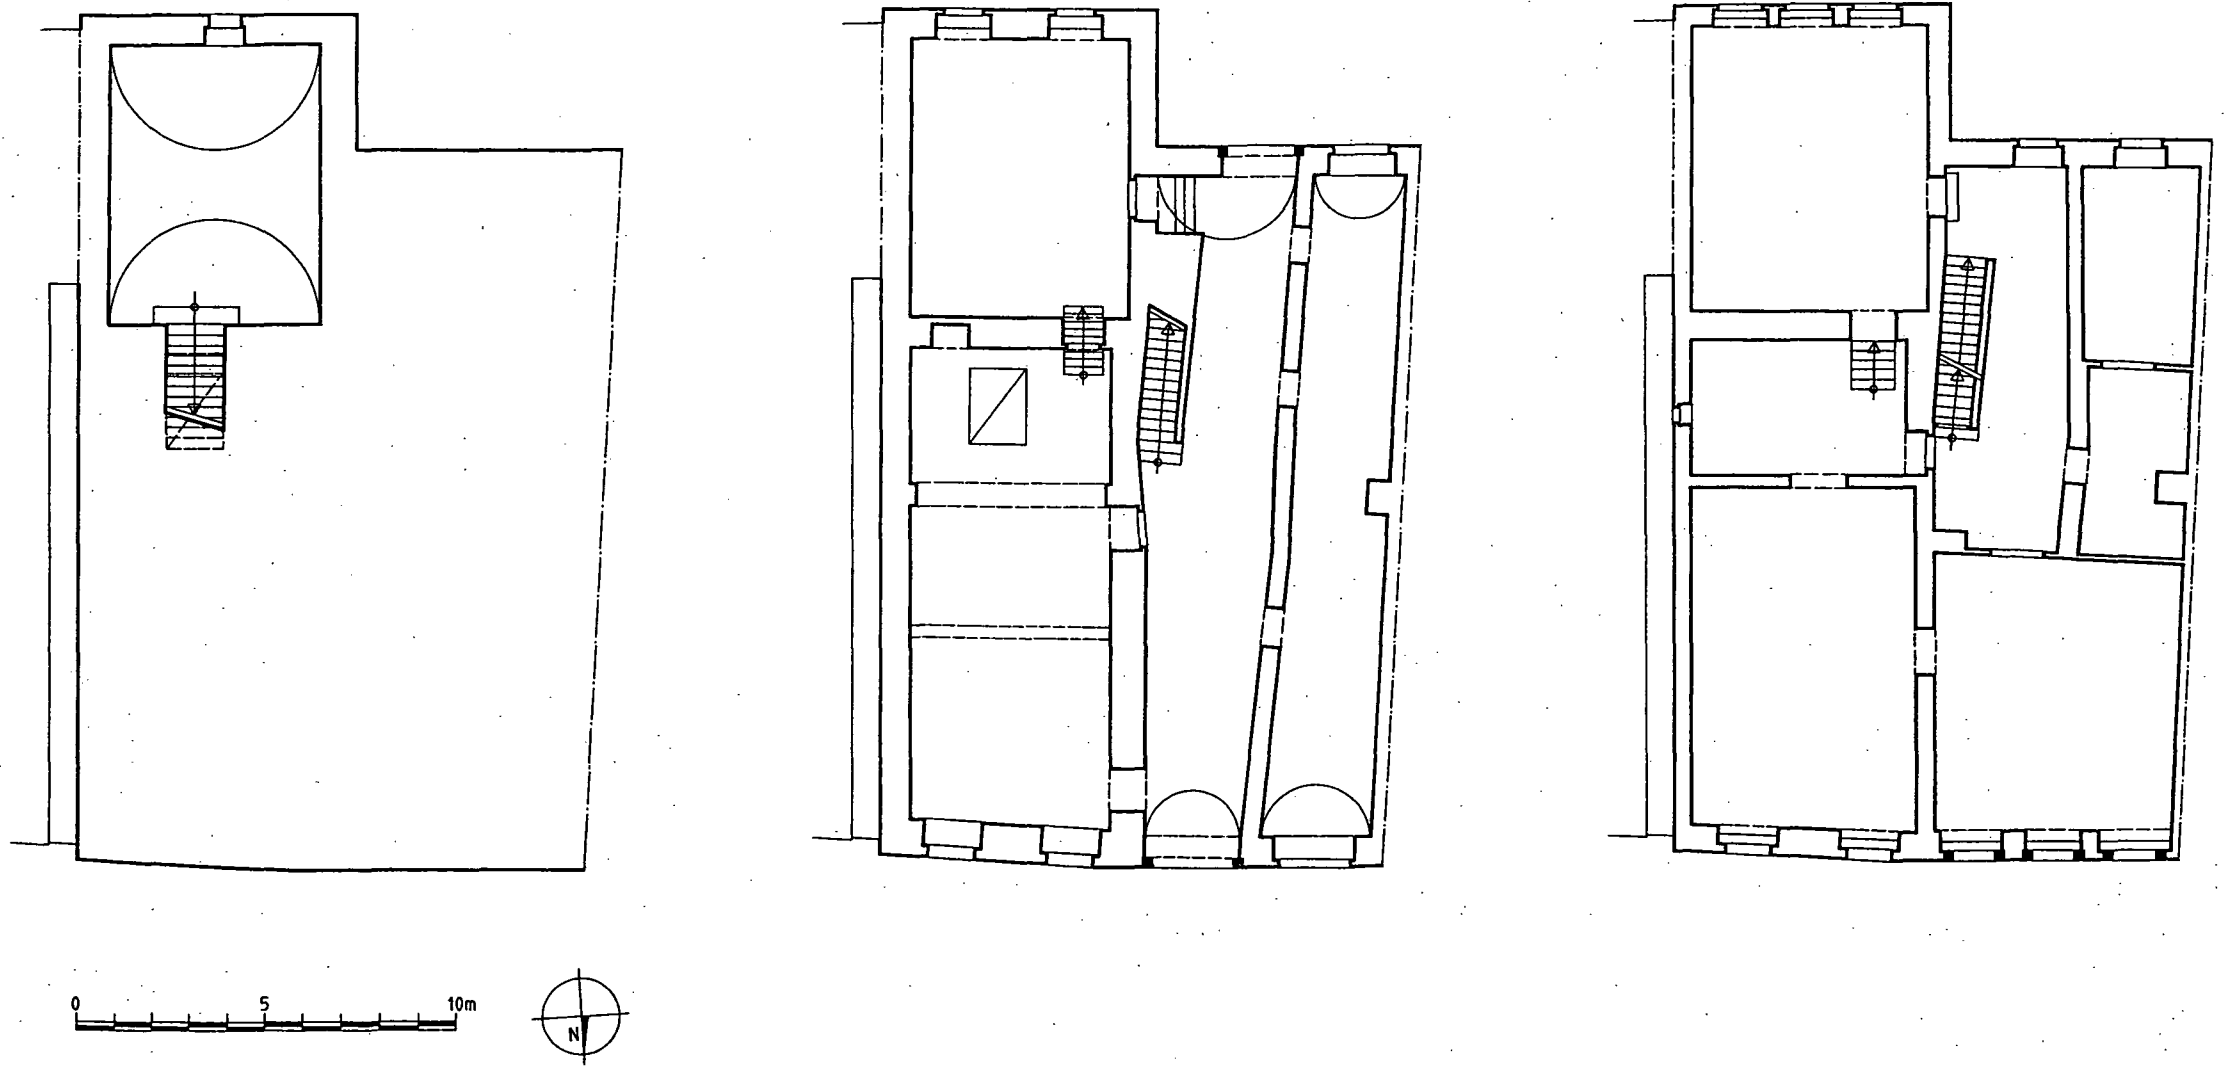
Stadtplatz 17 – Grundrisse Keller, Erdgeschoss, Obergeschoss (1:200).
